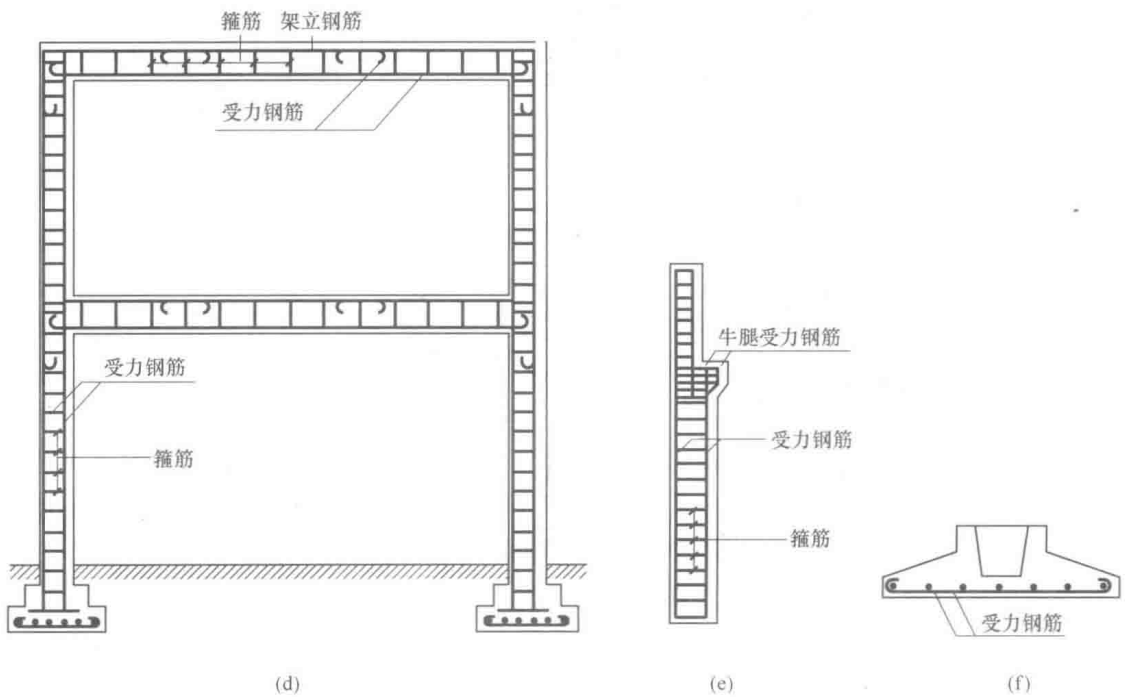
常见钢筋混凝土结构和构件配筋实例（二）
